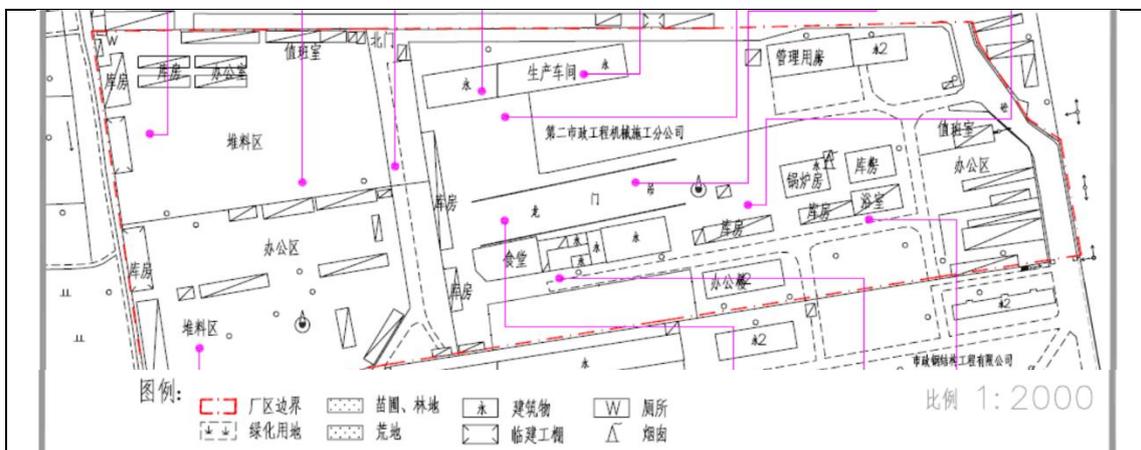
北京第二市政工程机械施工分公司历史平面布置图
